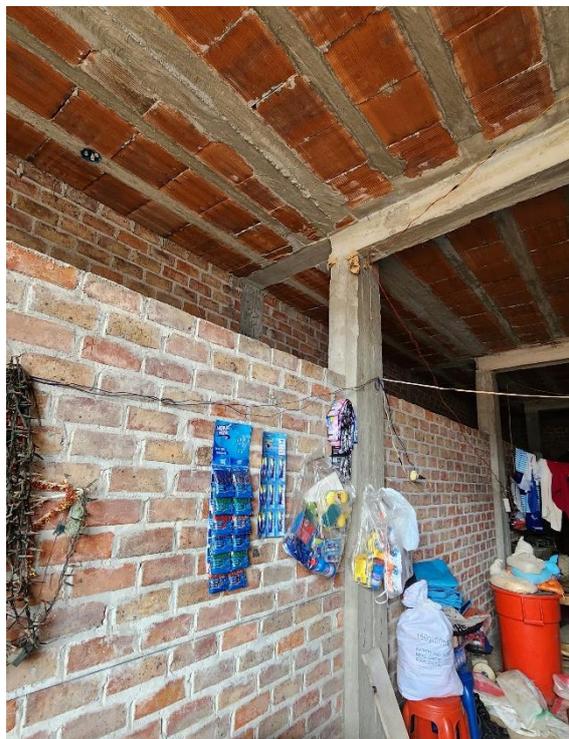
Muro con deficiencia en sus elementos debido a la mala práctica en la estabilización del suelo, antes de iniciar con el proyecto de construcción.
